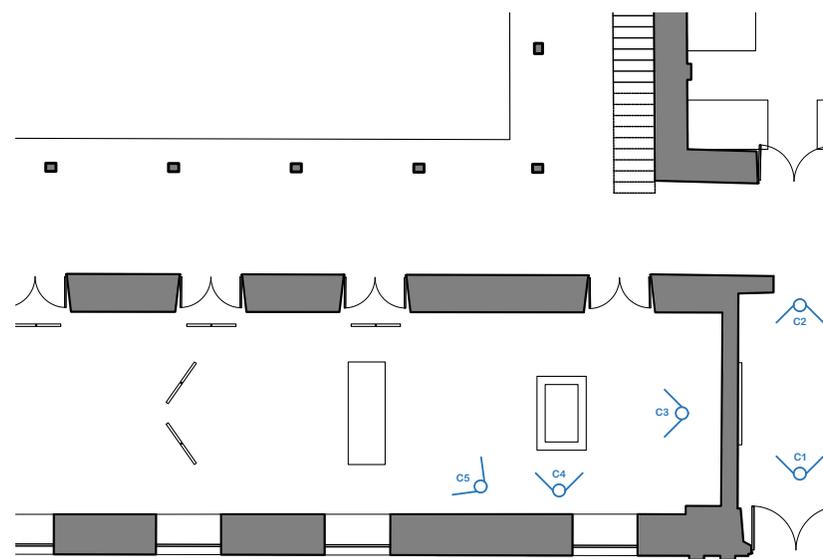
Planta Propuesta Zona de Exhibición (B2)
